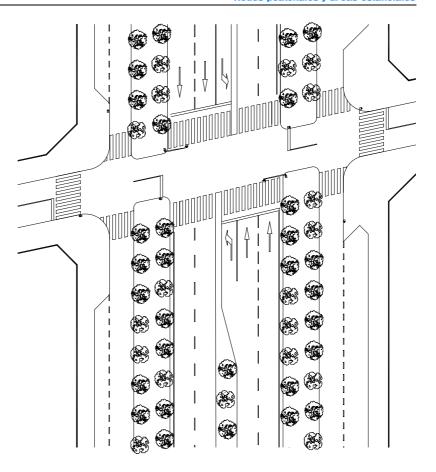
EJEMPLO DE DISEÑO EN PLANTA DE UN BULEVAR DE ANDENES LATERALES (Fuente: Jacobs, B. 1995)
